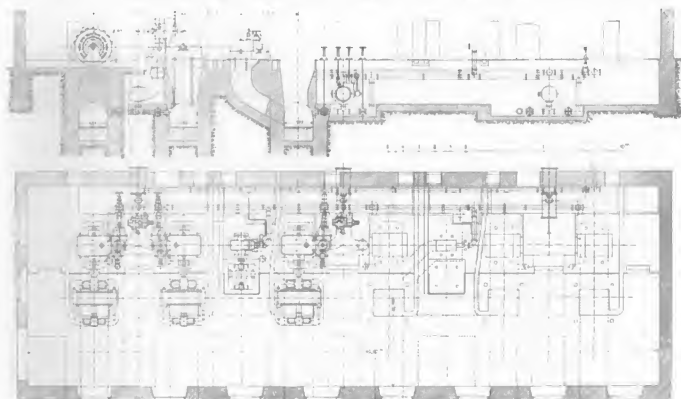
Grundriss und Längenschnitt des Maschinenhauses. — Massstab 1:225.
